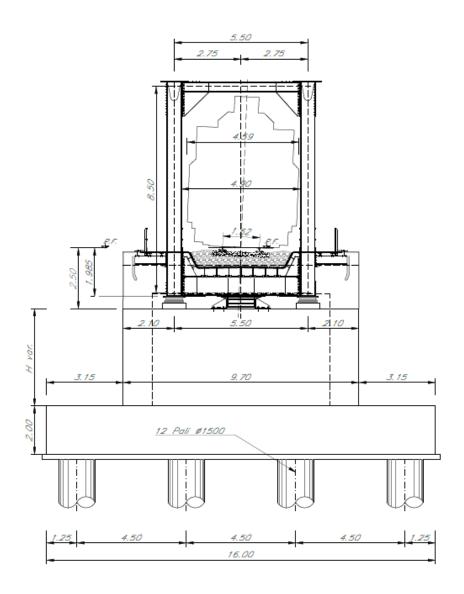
Spalla reticolare a via inferiore singolo binario – prospetto trasversale
